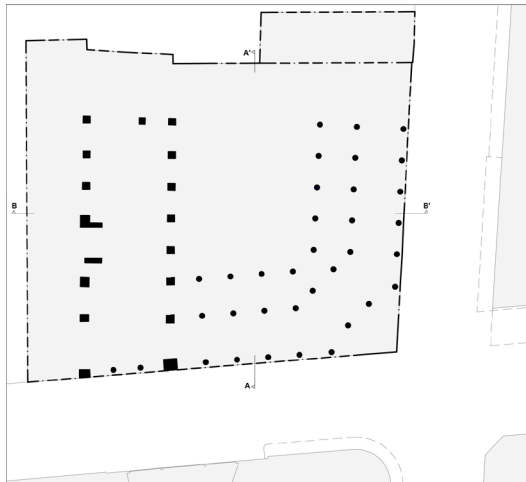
Planta baja de lo mantenido. (Autoría propia, 2021).
